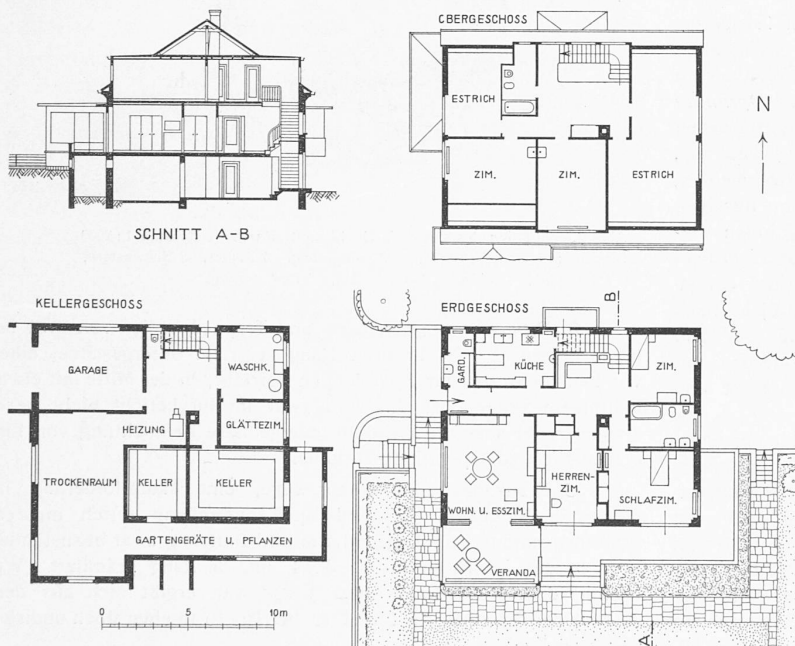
Grundrisse und Schnitt. — Masstab 1:400.
